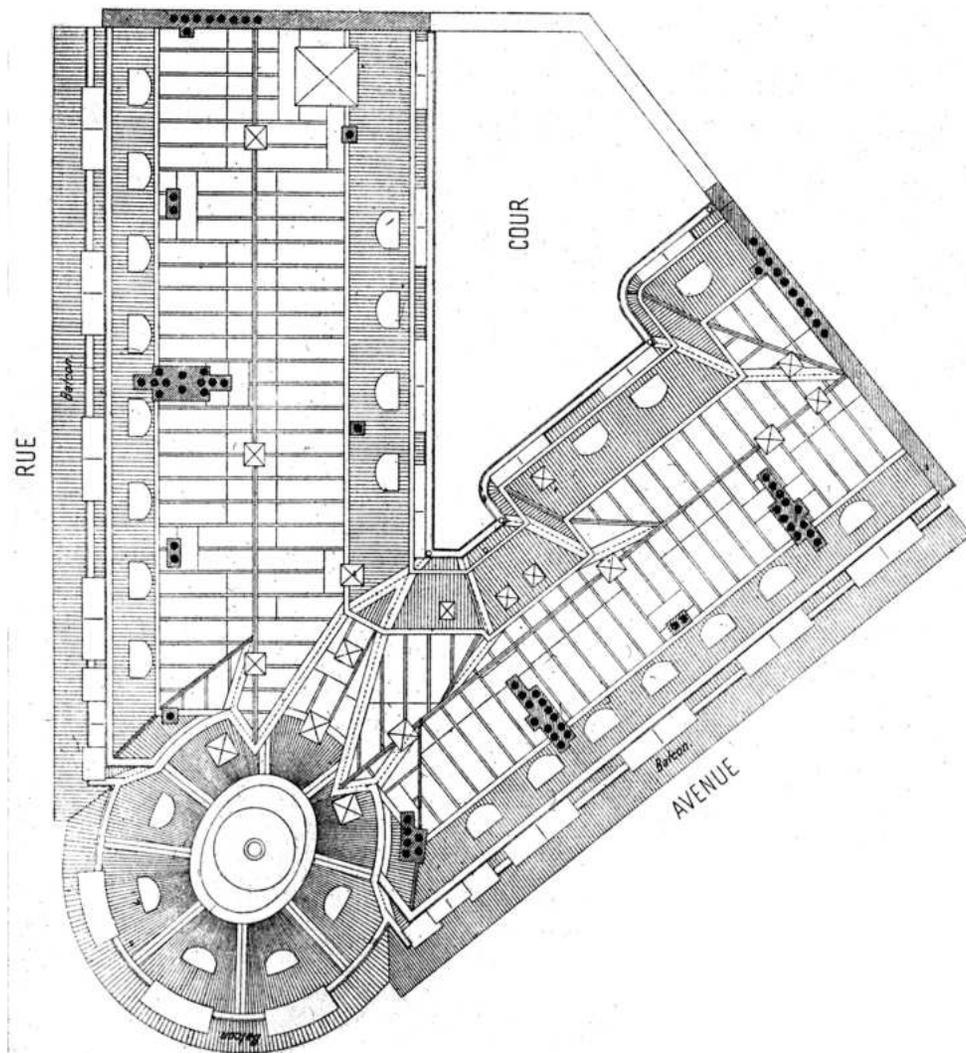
Plan de toiture d'un immeuble d'angle (début du xx^e siècle)
